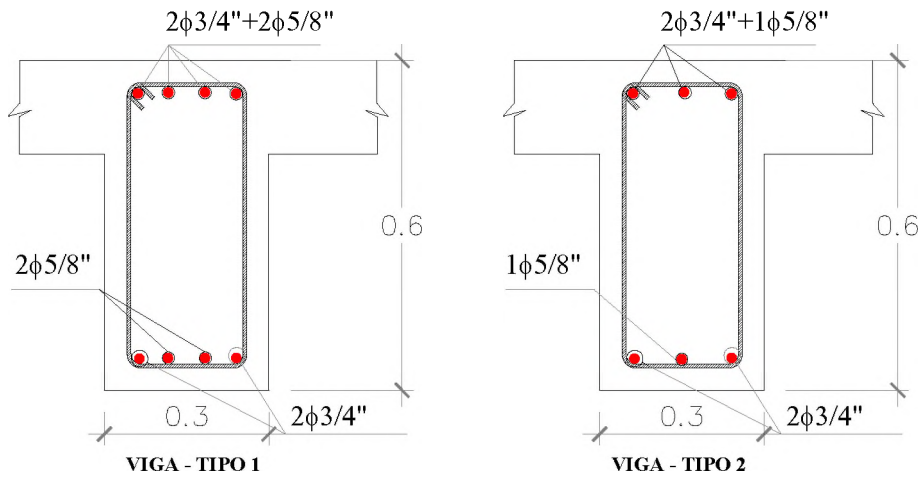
Tipos de vigas de concreto armado en el edificio de ocho niveles.
